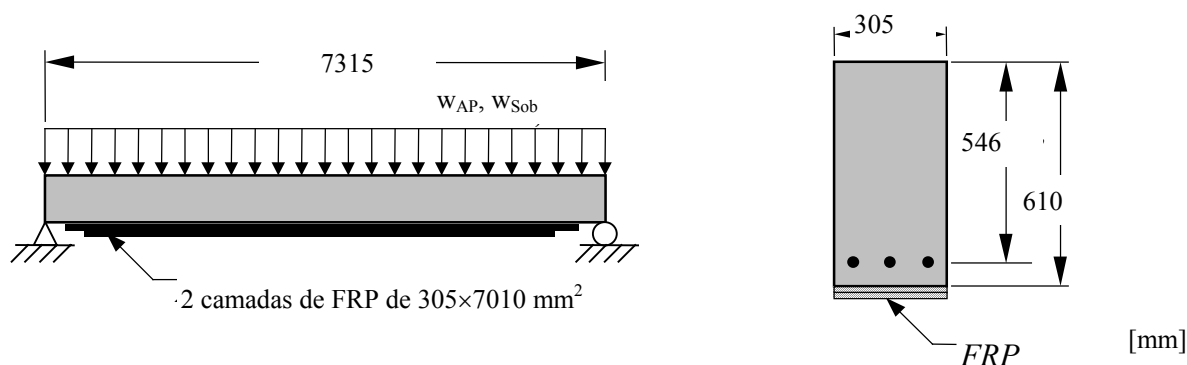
Esquema de reforço à flexão de viga de betão armado, por colagem externa de FRP.
